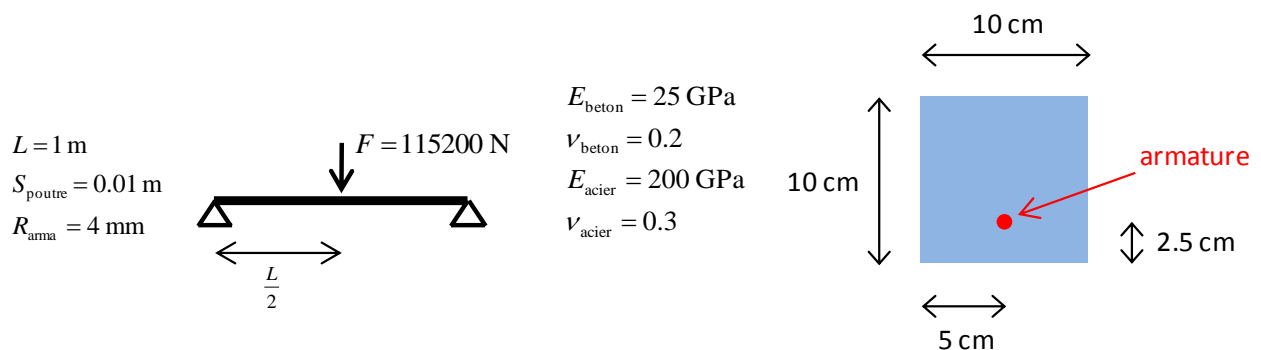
Schéma du problème étudié : poutre sur deux appuis (à gauche) et détail de sa section (à droite).
